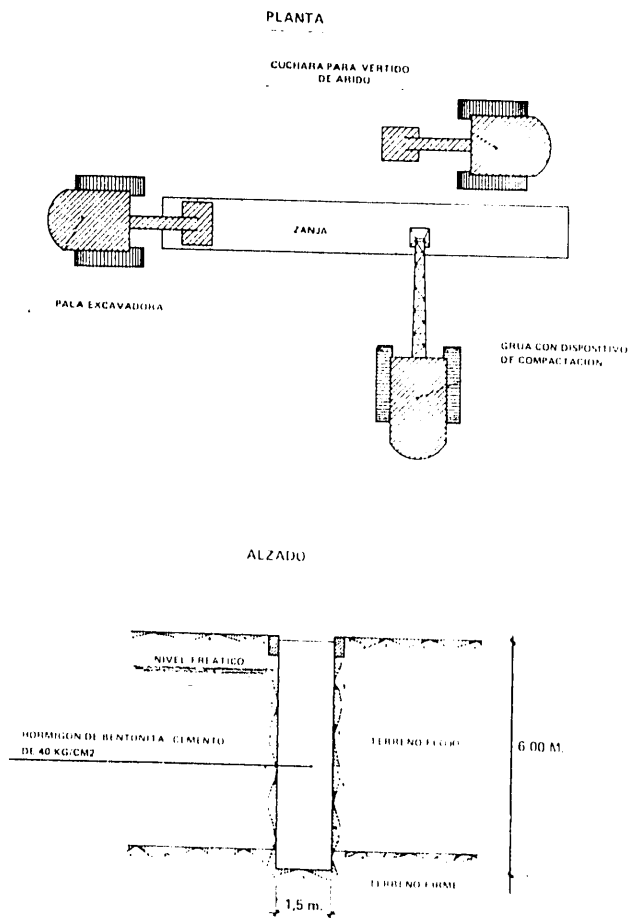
Cimentación mediante zapata corrida semidura; excavación continua con bentonita-cemento y relleno posterior de árido compactado.
